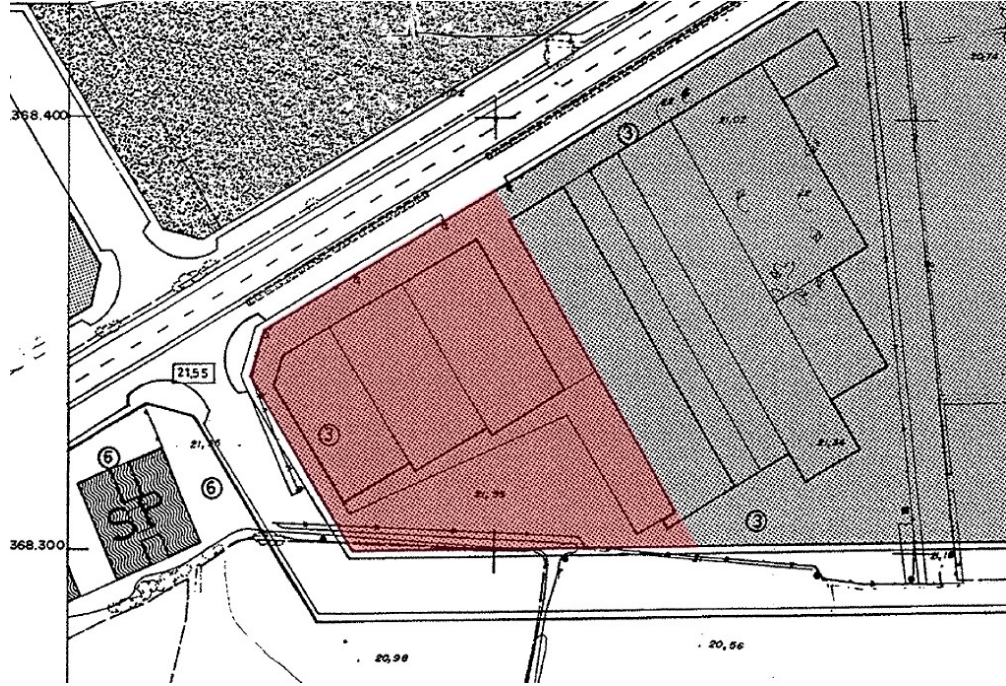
solar edificable delimitado dentro de la ordenación actual del PGOU
